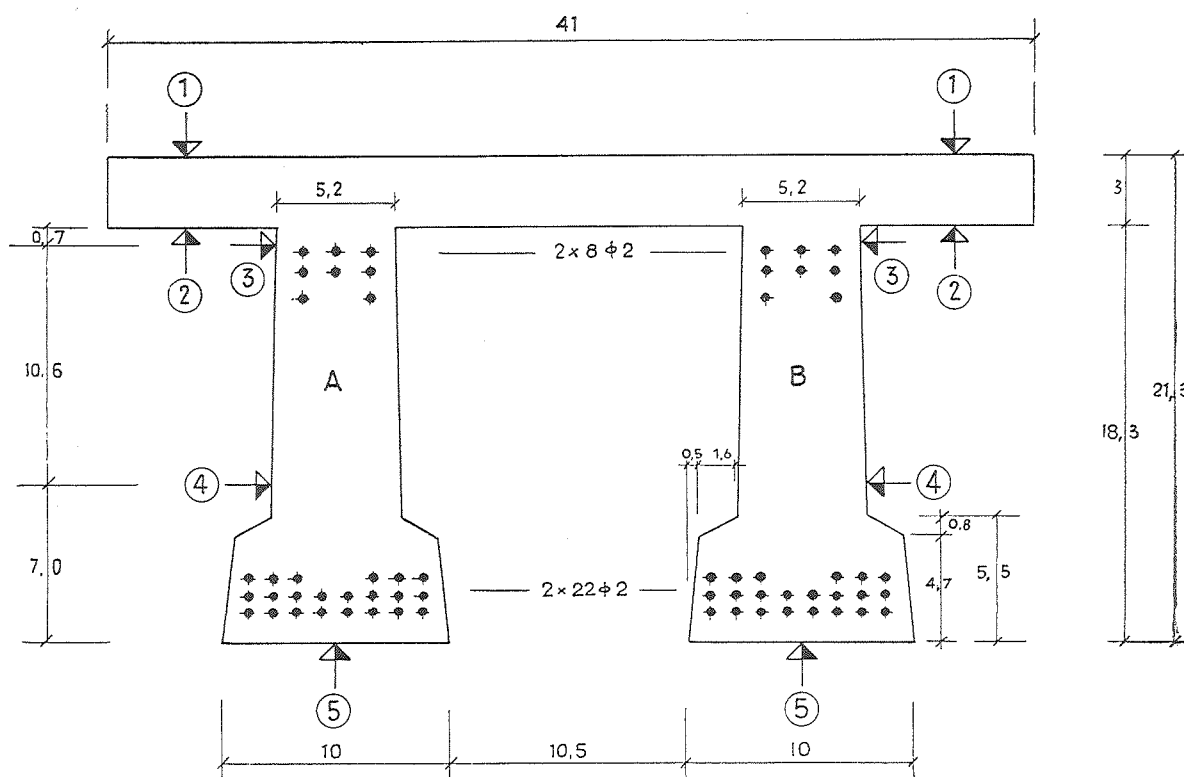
Sezione della trave sperimentata e posizione degli estensimetri.
